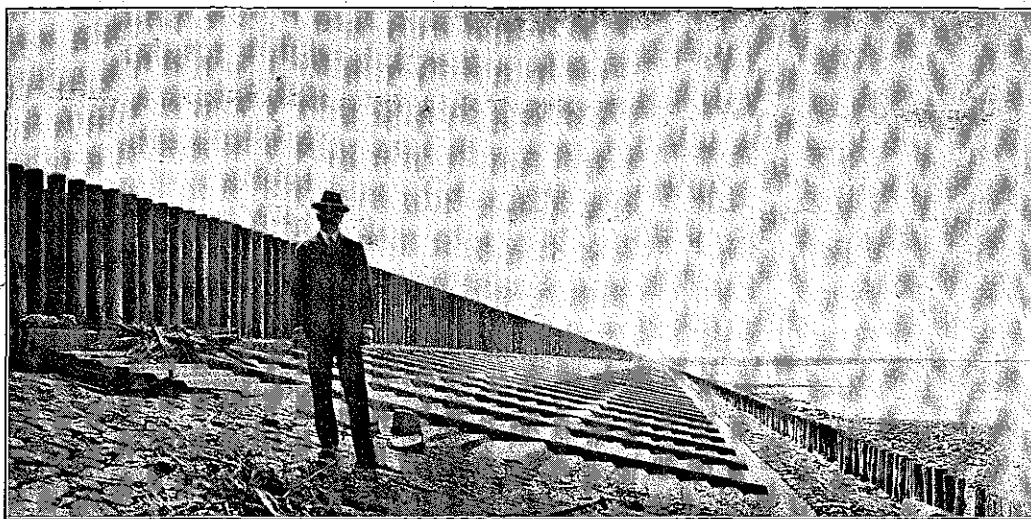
Betonwerk aan den Langendijk van Schouwen, gebouwd in 1908. (Foto genomen in 1930)
